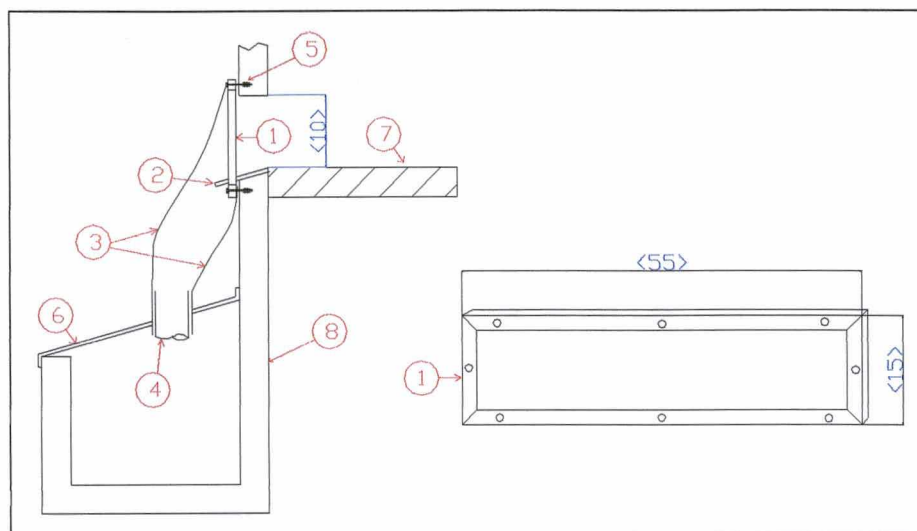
Canal coberto conectado à abertura de saída de dejetos das baias por peça em PVC flexível: 1 – estrutura PVC rígido com furos (função de fixar a peça em PVC); 2 – chapa saída de dejetos (PVC rígido); 3 – peça PVC flexível; 4 – tubo PVC rígido com diâmetro de 100mm; 5 – parafuso PVC rígido; 6 – cobertura do canal, em PVC rígido; 7 – piso da baia; 8 – canal existente
